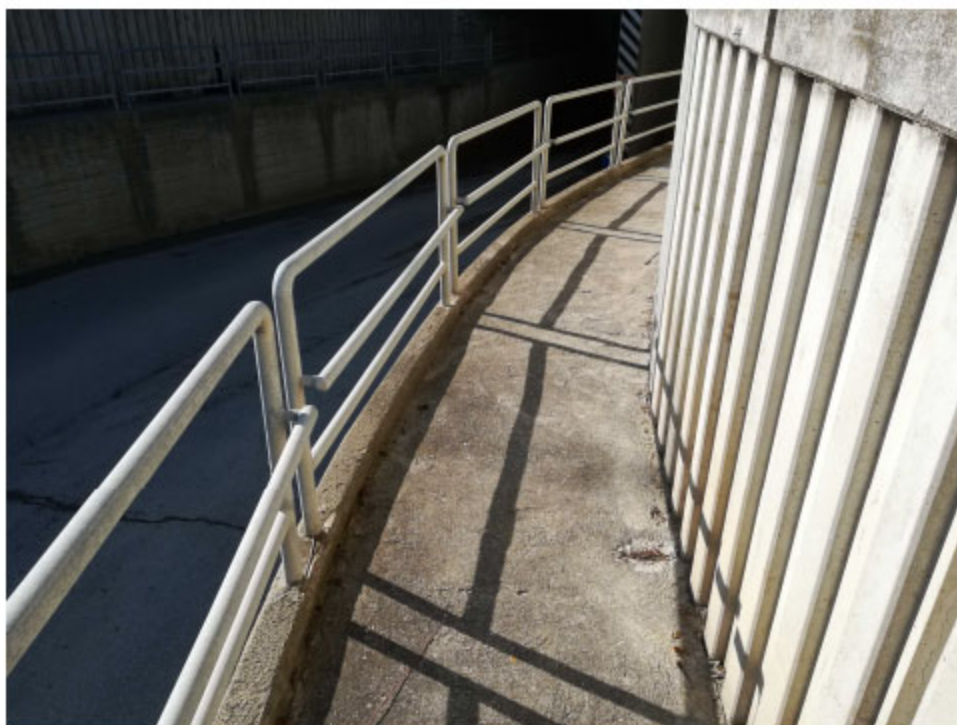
Dettaglio camminamenti laterali – sostituzione balaustra, rifacimento pavimentazione del tipo bituminosa.
